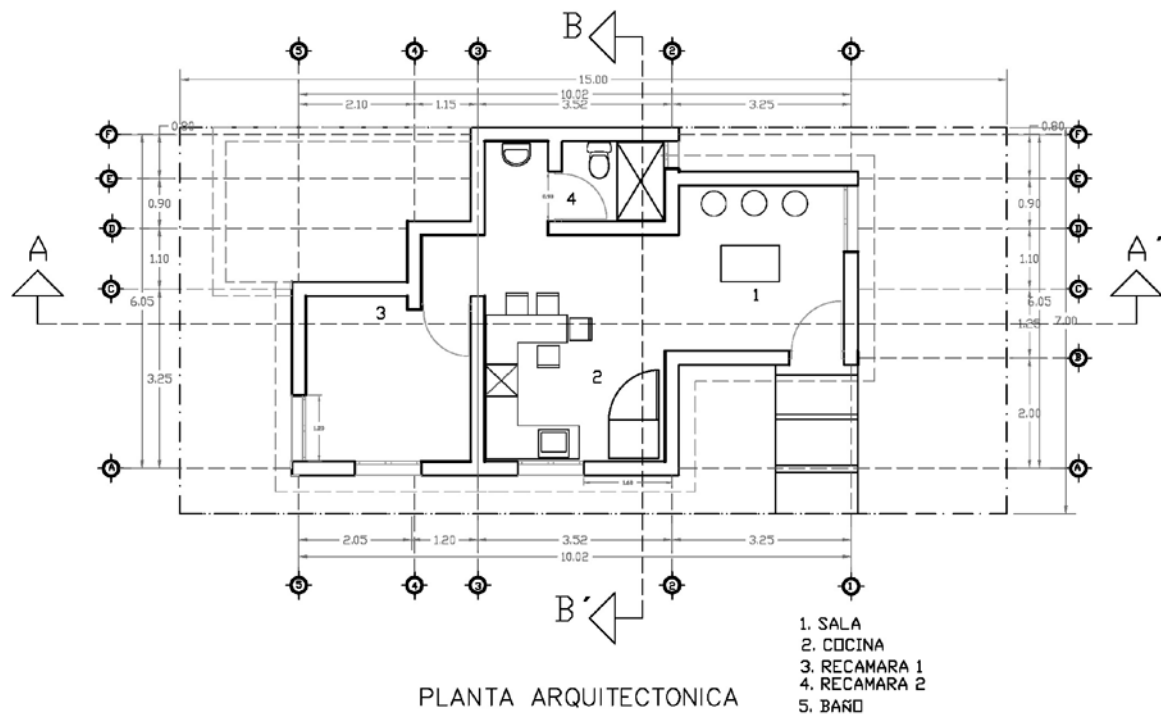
Plano de planta arquitectónica de vivienda experimental sustentable
